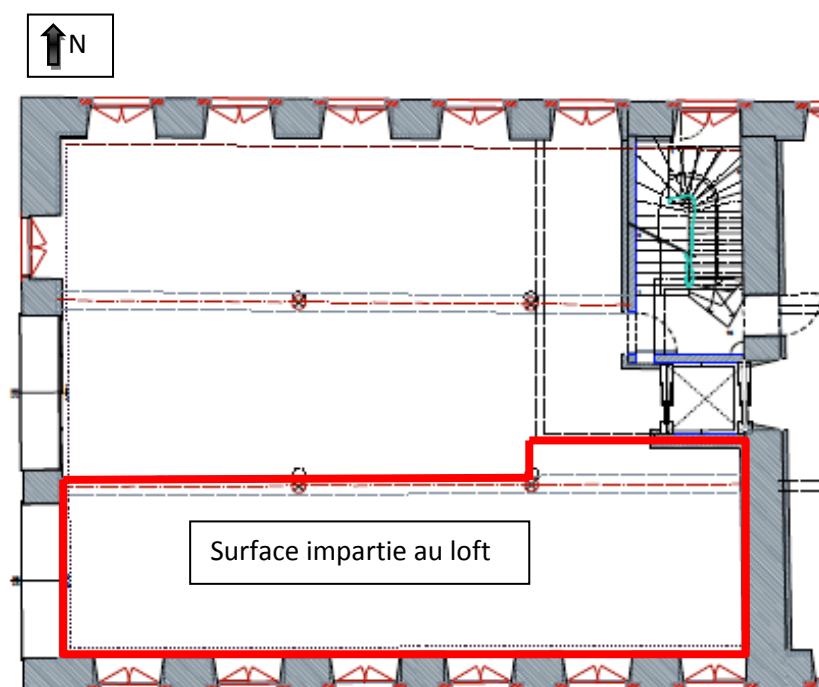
Vue en plan du plateau RDC du bâtiment C avant aménagement. Ech : environ 1/200.
